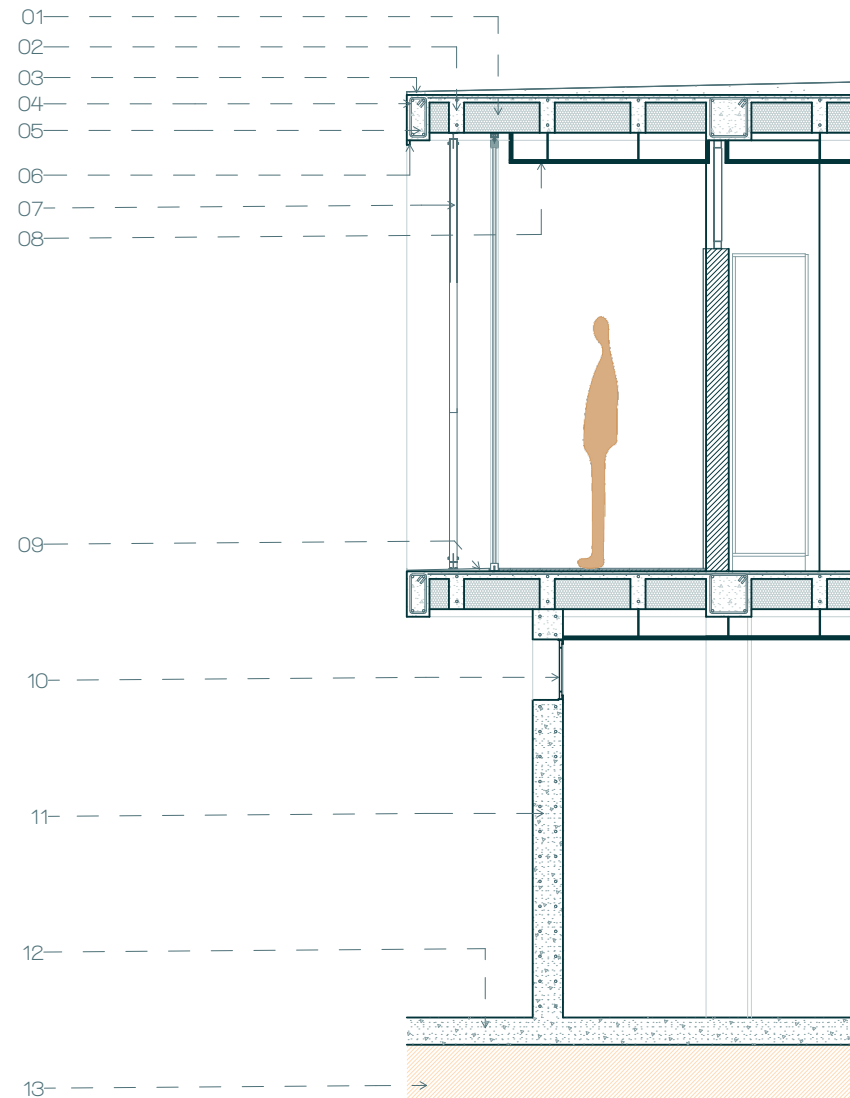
Detalle de Fachada Genérica Bloque A (Autores, 2023)
